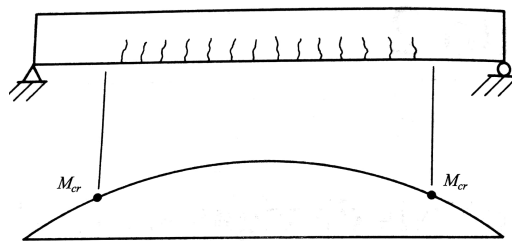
Perfil de una viga de concreto sin refuerzo con agrietamiento en la zona de tensión [5]
